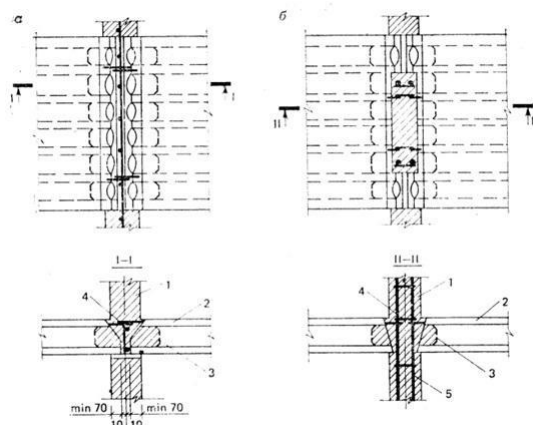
Узлы сопряжения многпустотных плит с монолитными стенами: а- в обычных условиях; б- в сейсмических районах: 1 - монолитная стена; 2 — многпустотные плиты перекрытий; 3 — заглушка, устанавливаемая в пустотах; 4 — арматурные связи; 5 — вертикальный арматурный каркас стены
